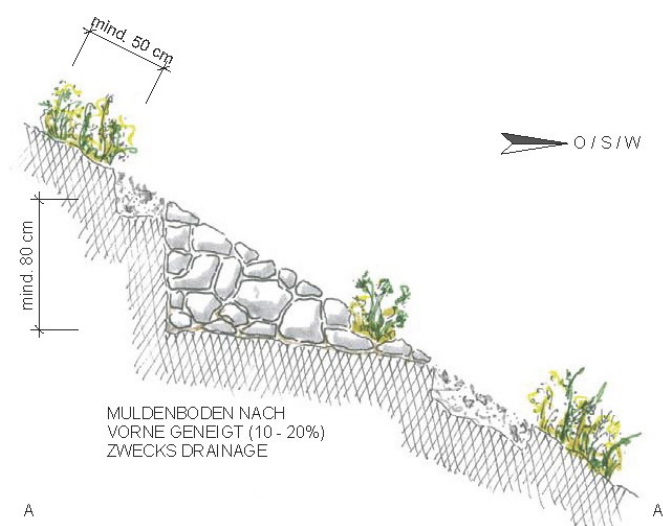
Coupe transversale d'une niche pierreuse (source : Barbara Kirsch / Karch)
